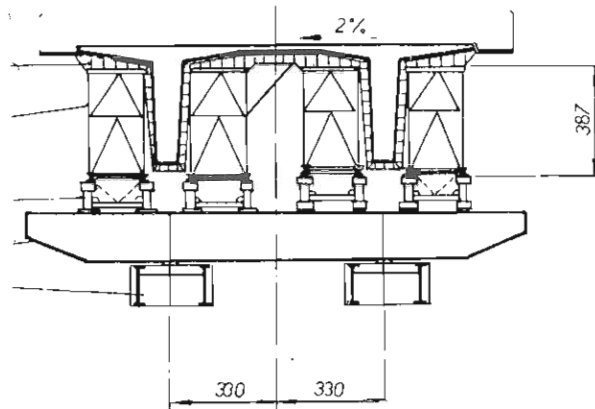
Sección de la cimbra-encofrado del puente sobre el río Sazava.
